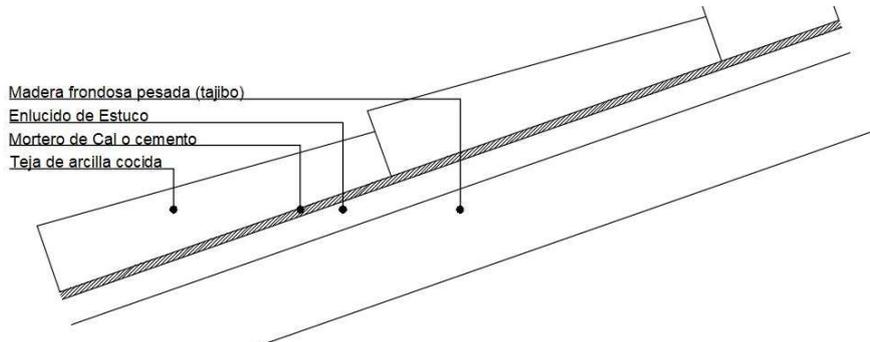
Sección de la cubierta tradicional cruceña.
